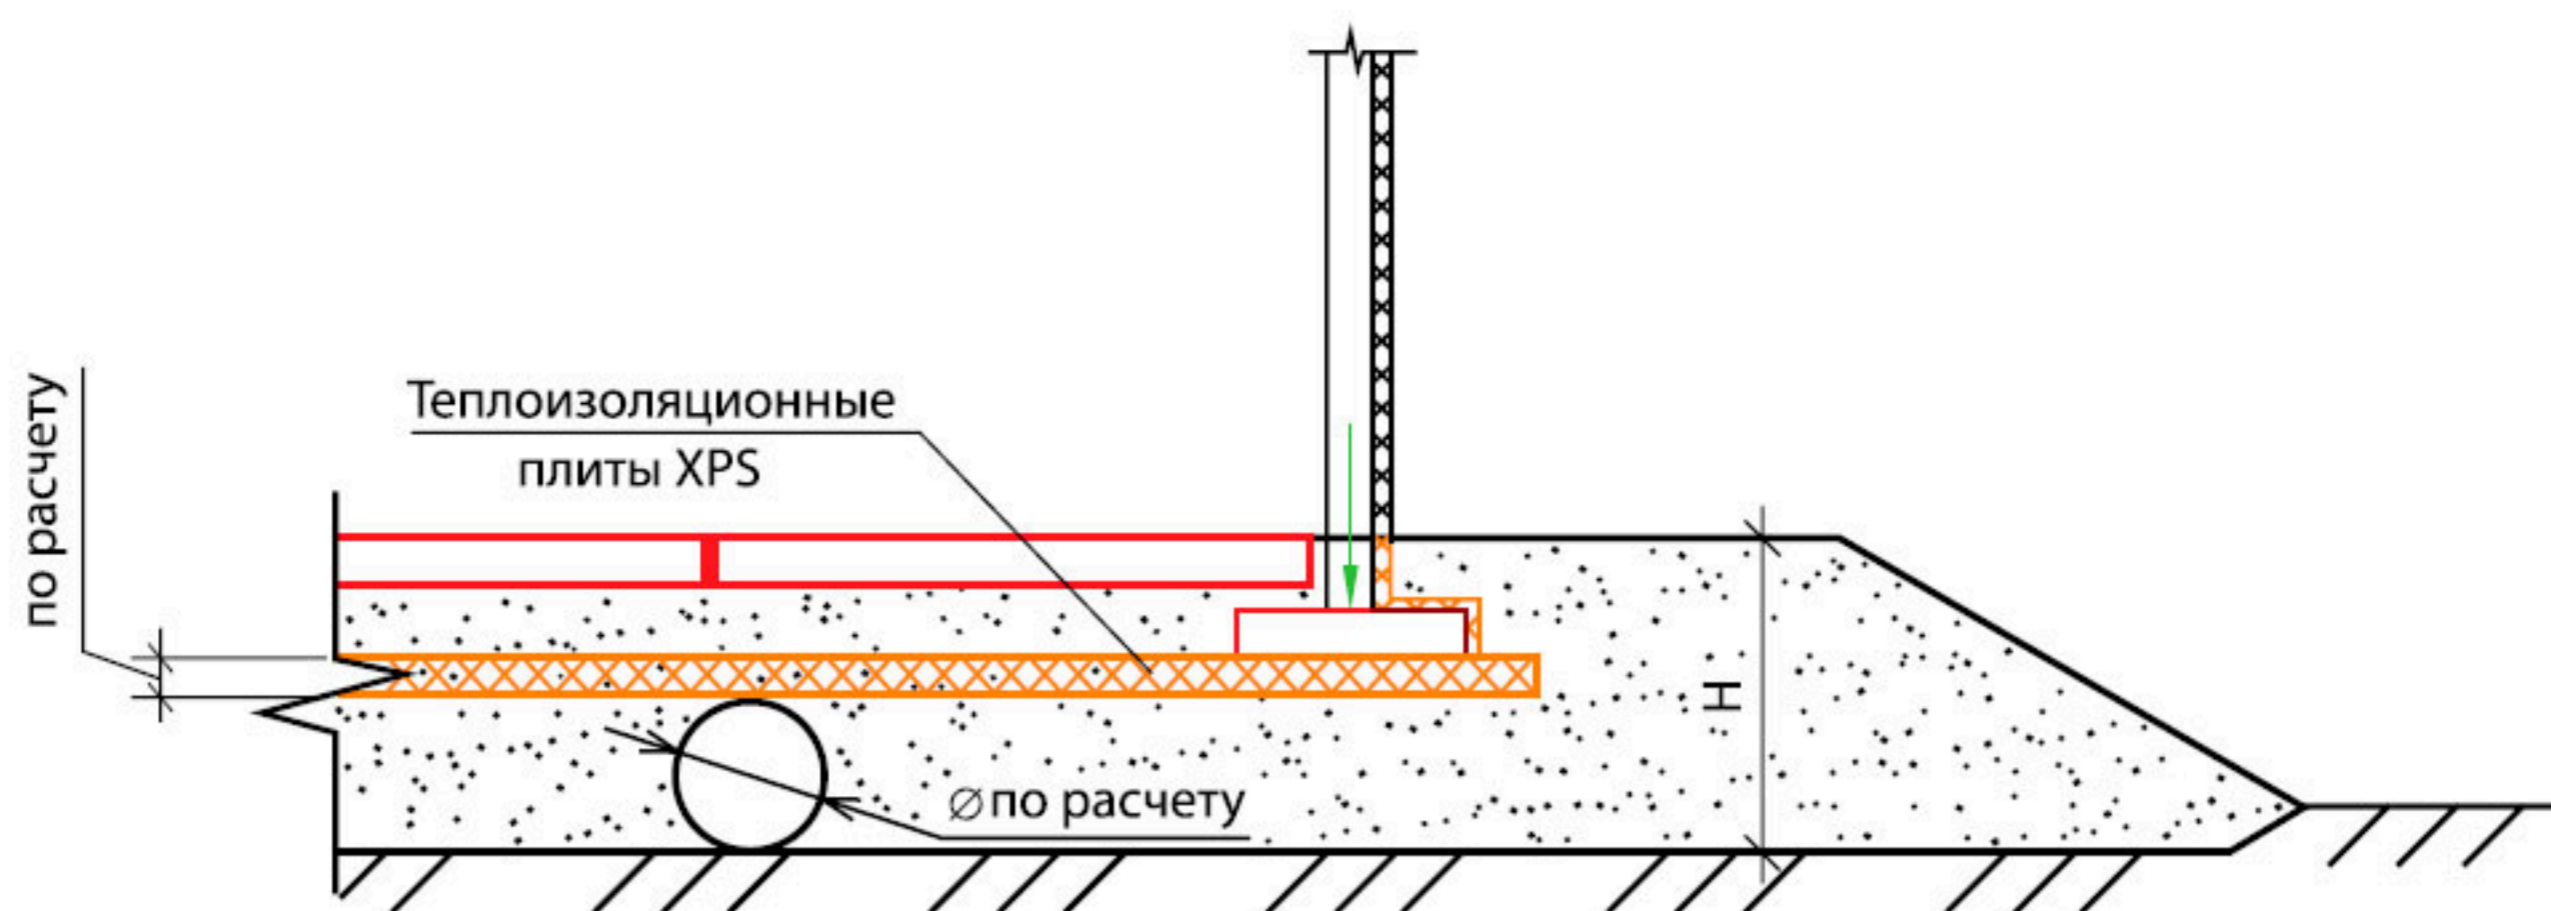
Схема обустройства фундамента на многолетнемерзлом грунте с XPS теплоизоляцией и трубной системой вентиляции
